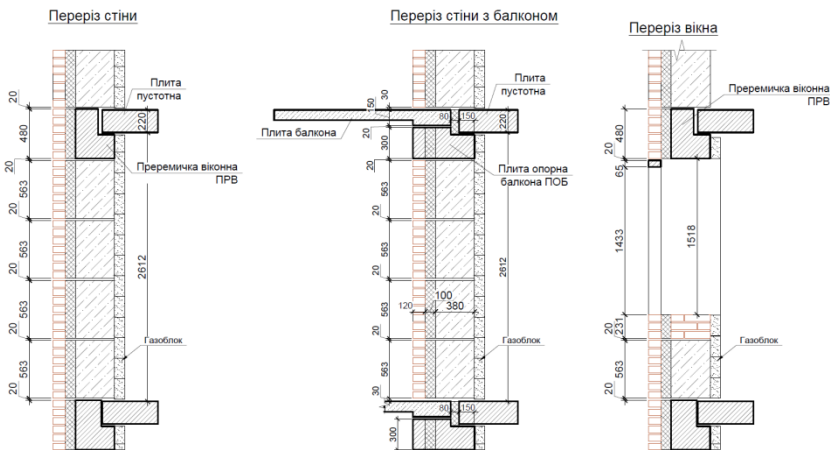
Перерізи чотиришарового блоку несучої стіни житлової будівлі
